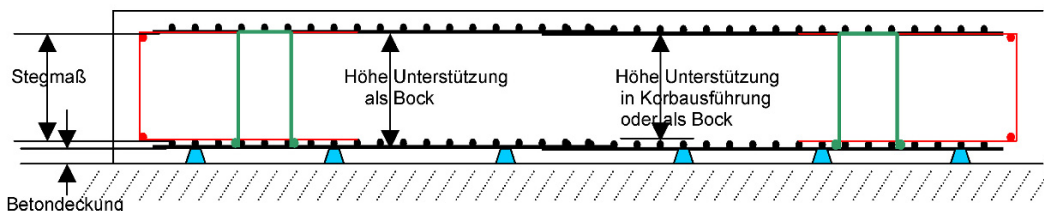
Einfache Maßketten an der horizontalen Platte unter Beachtung der Lage der Matten.
